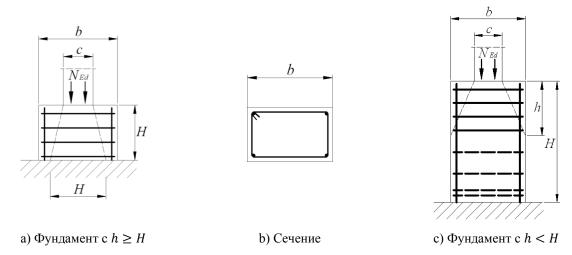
Арматура, воспринимающая раскалывающие усилия, фундаментов на скальных грунтах
